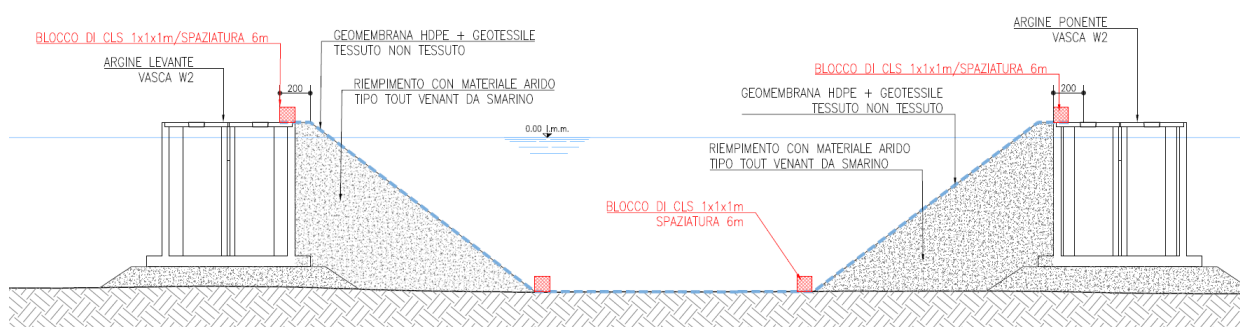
Sezione impermeabilizzazione della vasca W2
